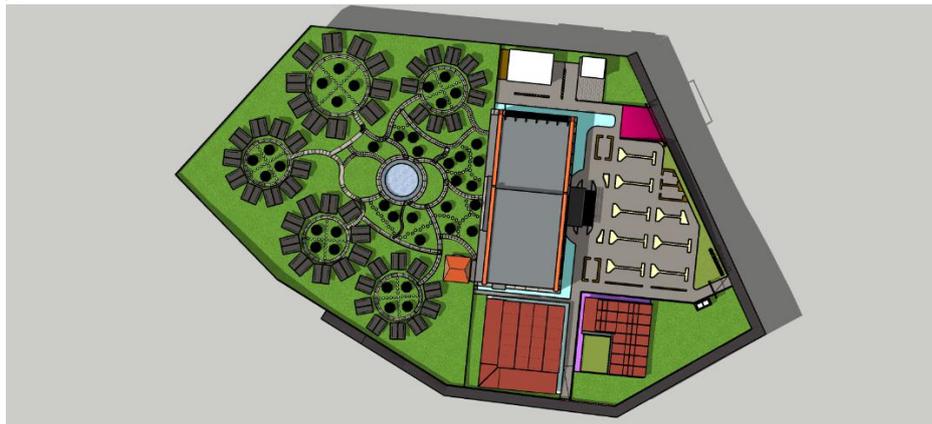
Pola Sirkulasi Ruang Antar Lantai Bangunan Lantai 1
